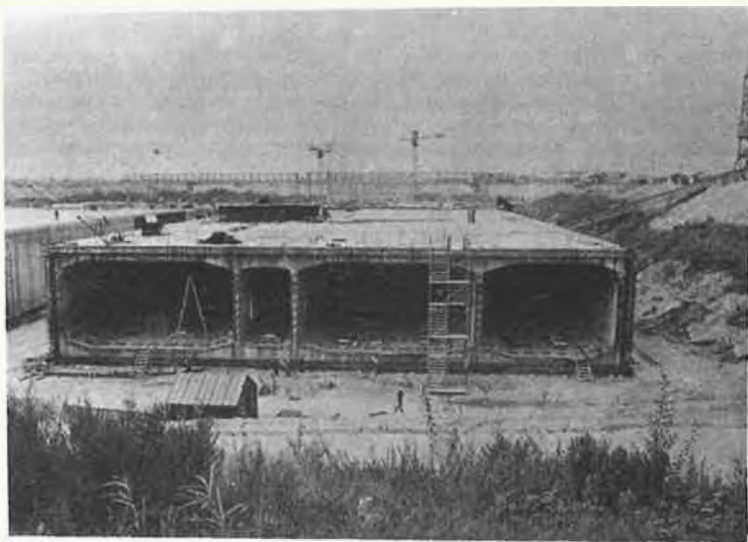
Construction du nouveau tunnel routier et ferroviaire sous l'Escaut à Anvers (1968).
